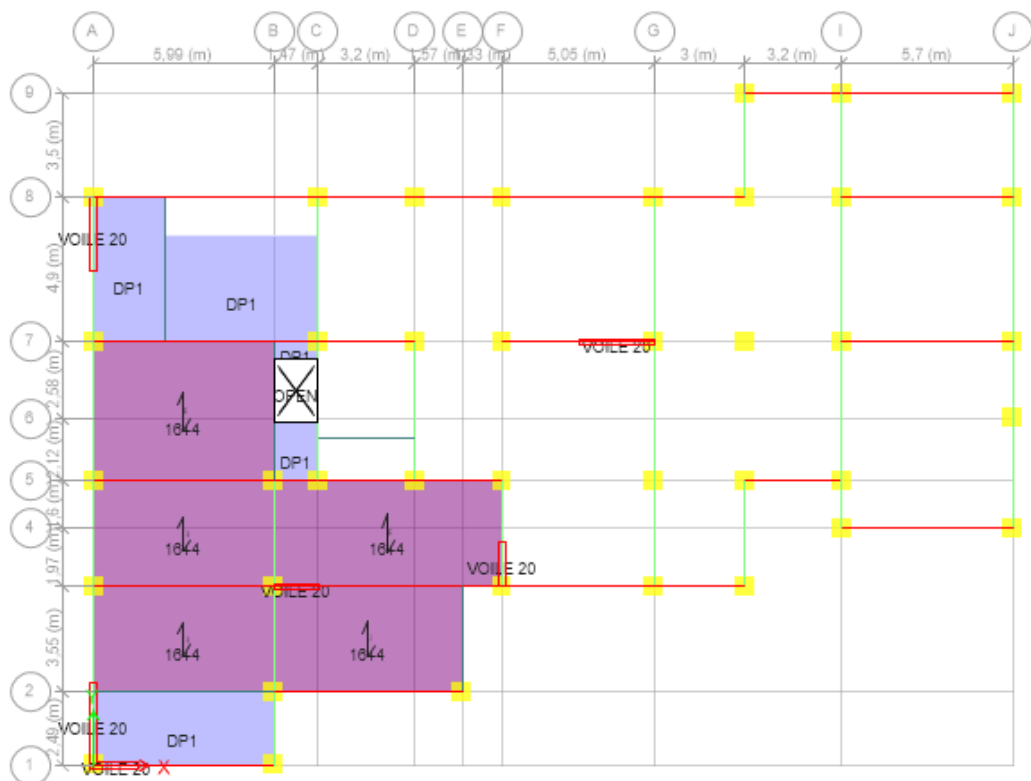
Schéma de la disposition des poutrelles pour l'entre sol
